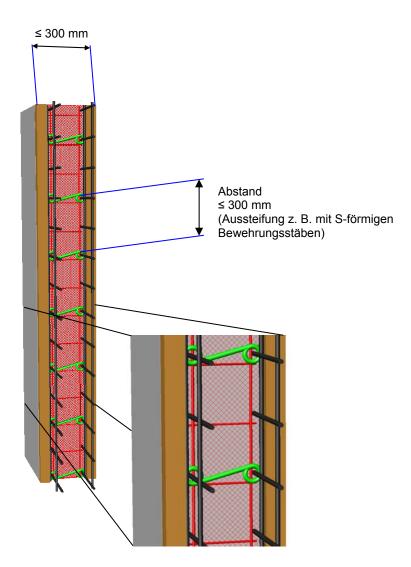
Detailansicht einer mit Stremaform geschalten Fuge bis 300 mm Dicke
